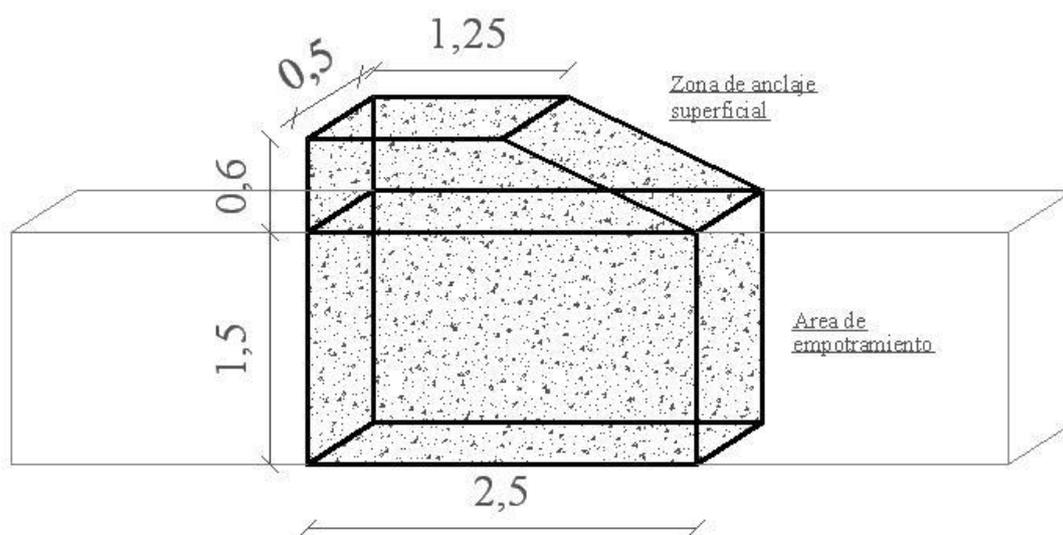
Muerto de hormigón para el anclaje de retención
